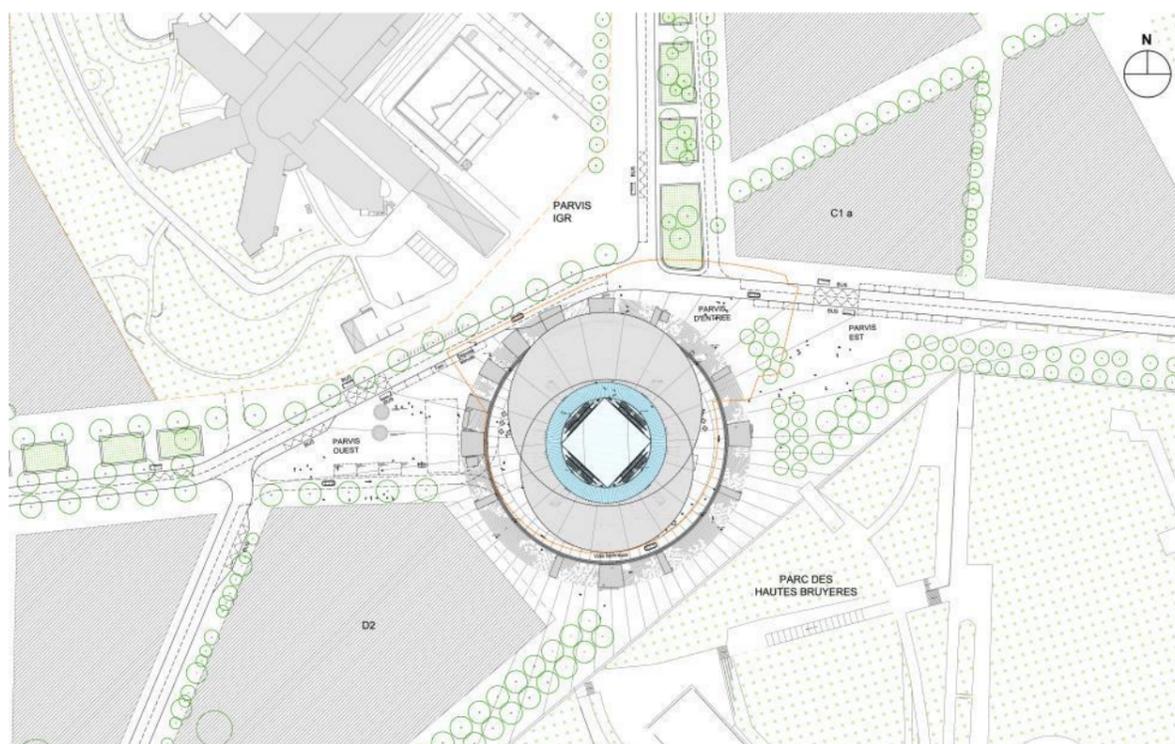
Gare de Villejuif IGR – Plan d'implantation
